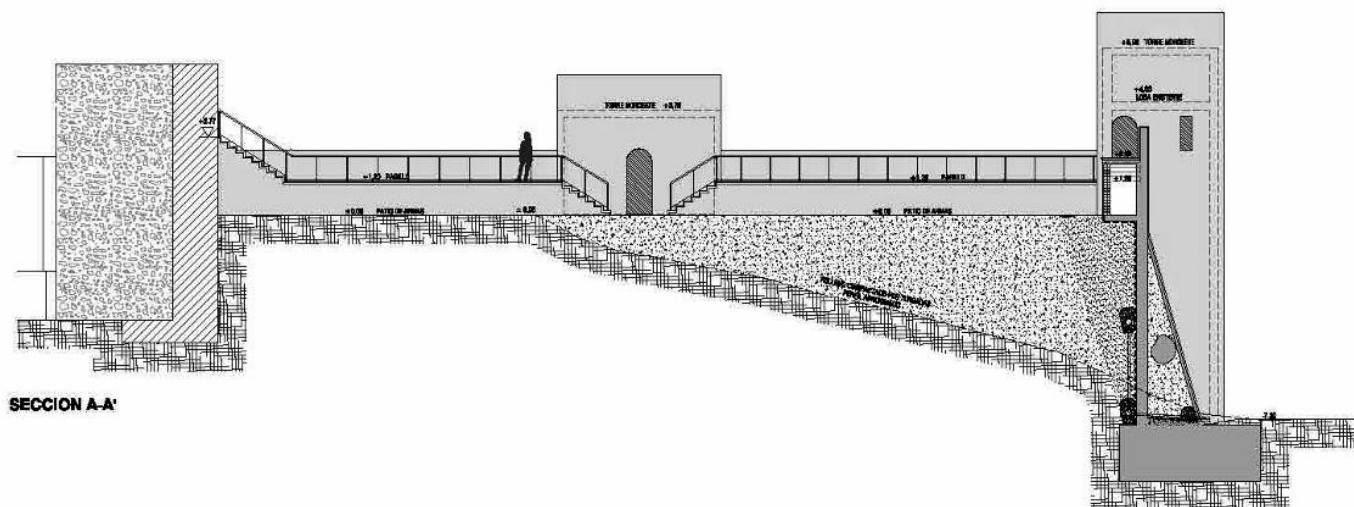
Sección transversal del talud entre las torres Noroeste y Norte. Estado modificado.
